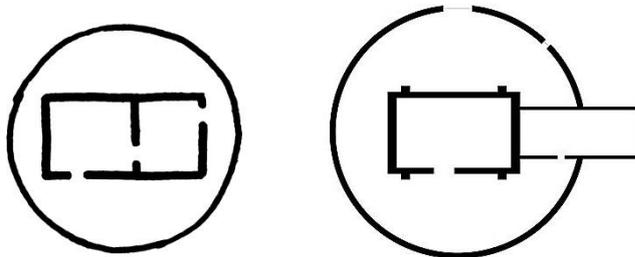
Planta esquemática de soporte del telescopio habitable.
